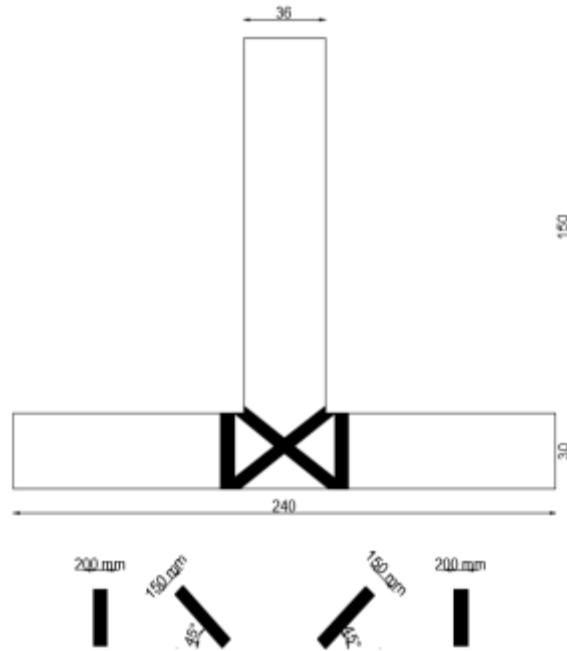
Referans-1 Elemanı geometrisi, donatı detayları ve kesit detayları
